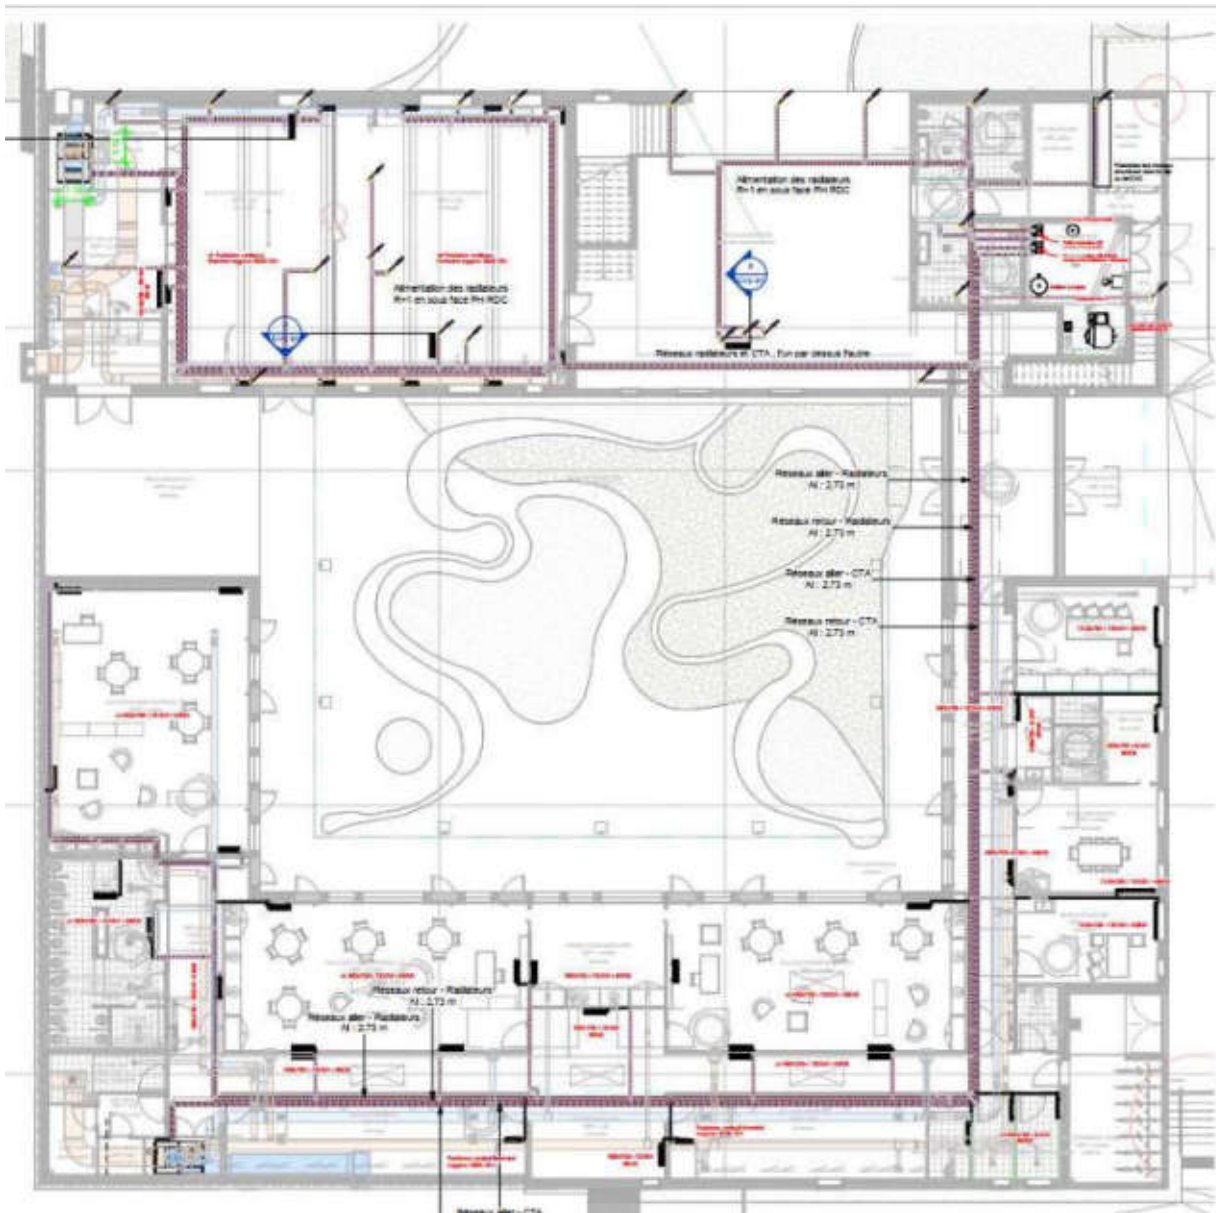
Plan projet : rez-de-chaussée (Source Client)
